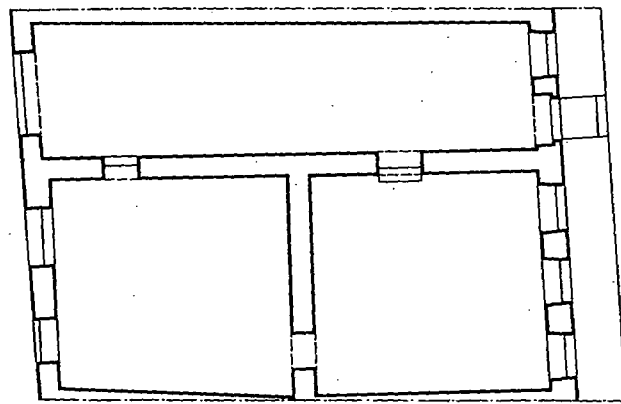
Ledererstraße 14 – Grundrisse Keller, Erdgeschoss (1:200).
